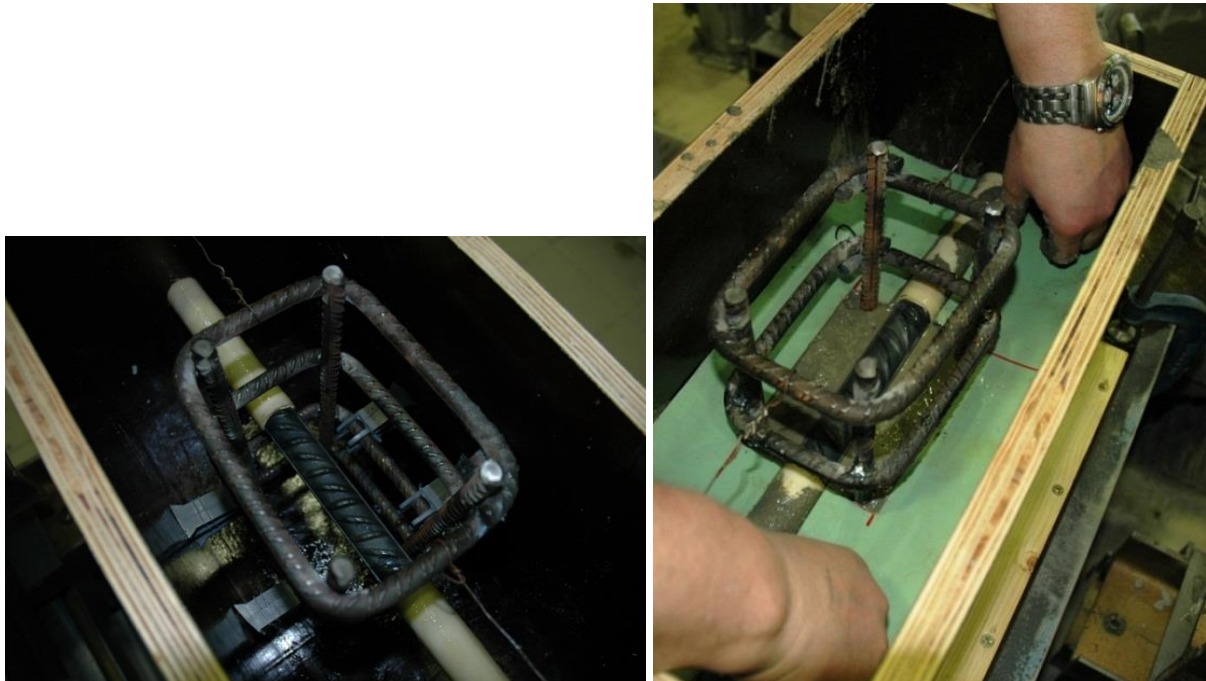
Aspeto final do varão principal e da armadura de confinamento no interior do molde e posicionamento da membrana, após betonagem da primeira camada de betão.
